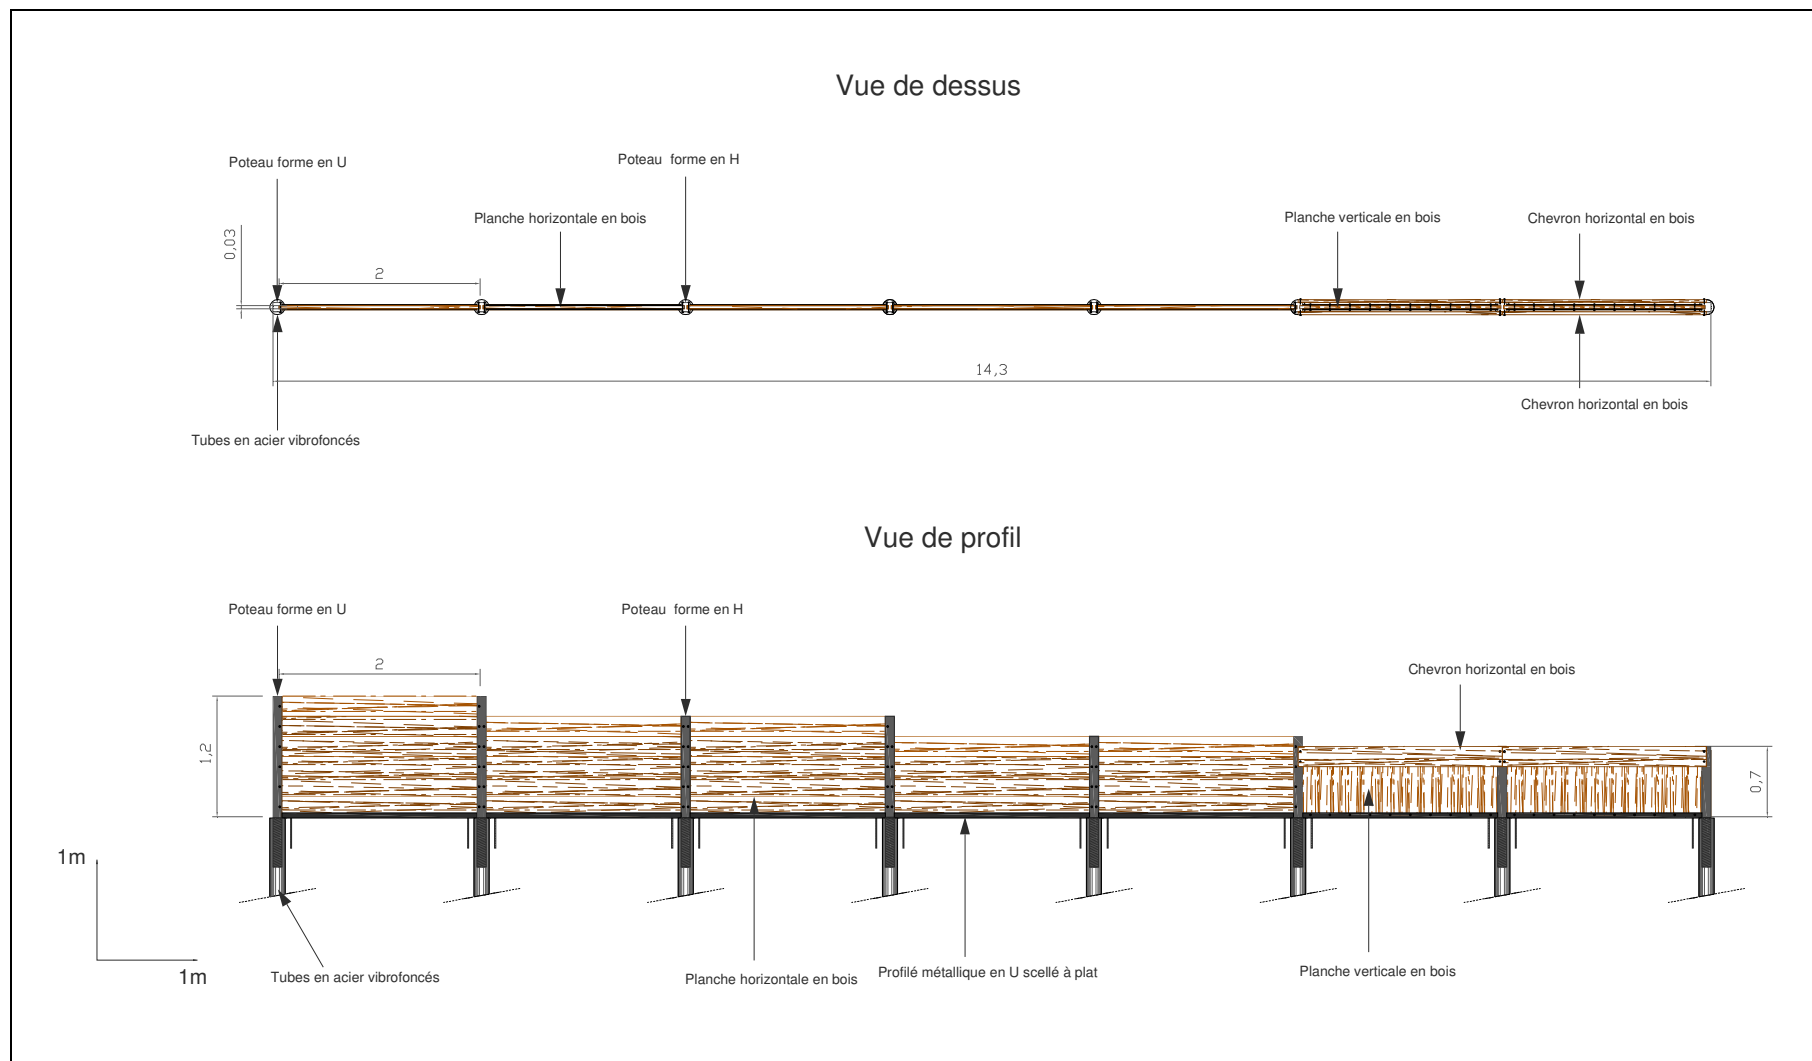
Coupe type d'un épi en bois à panneaux amovibles (ERAMM, 30/10/2014)
